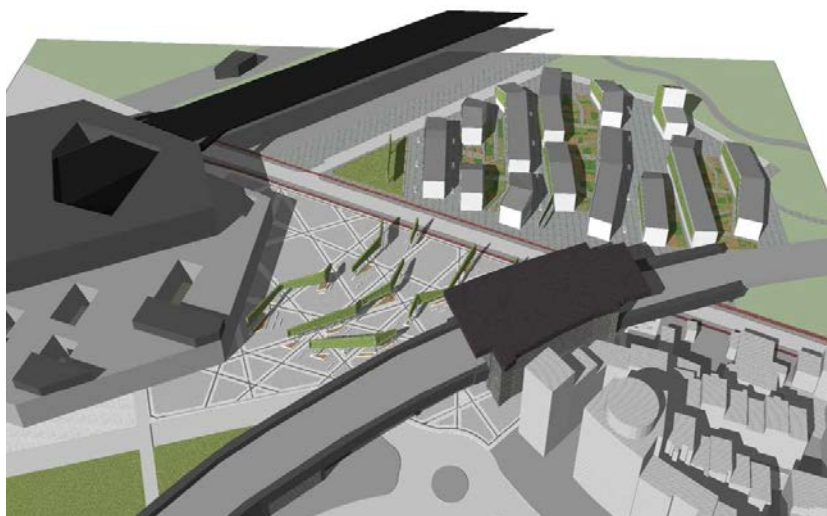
Bairro UP2: Organização Geral do Bairro.
